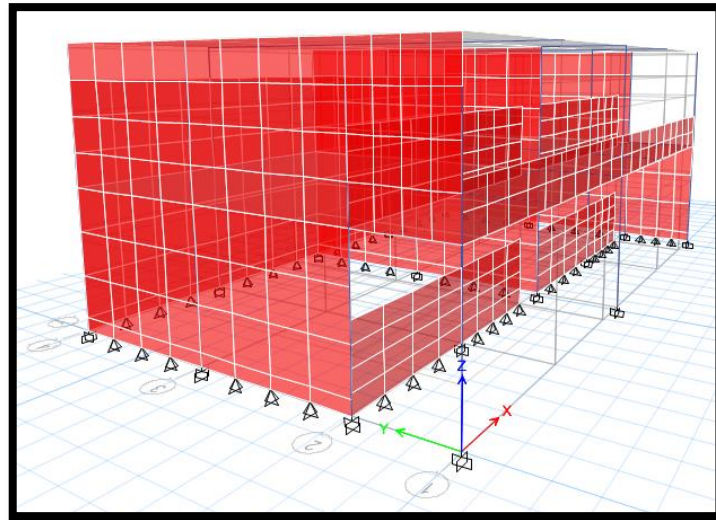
Asignación de apoyos en muros de albañilería y columnas
